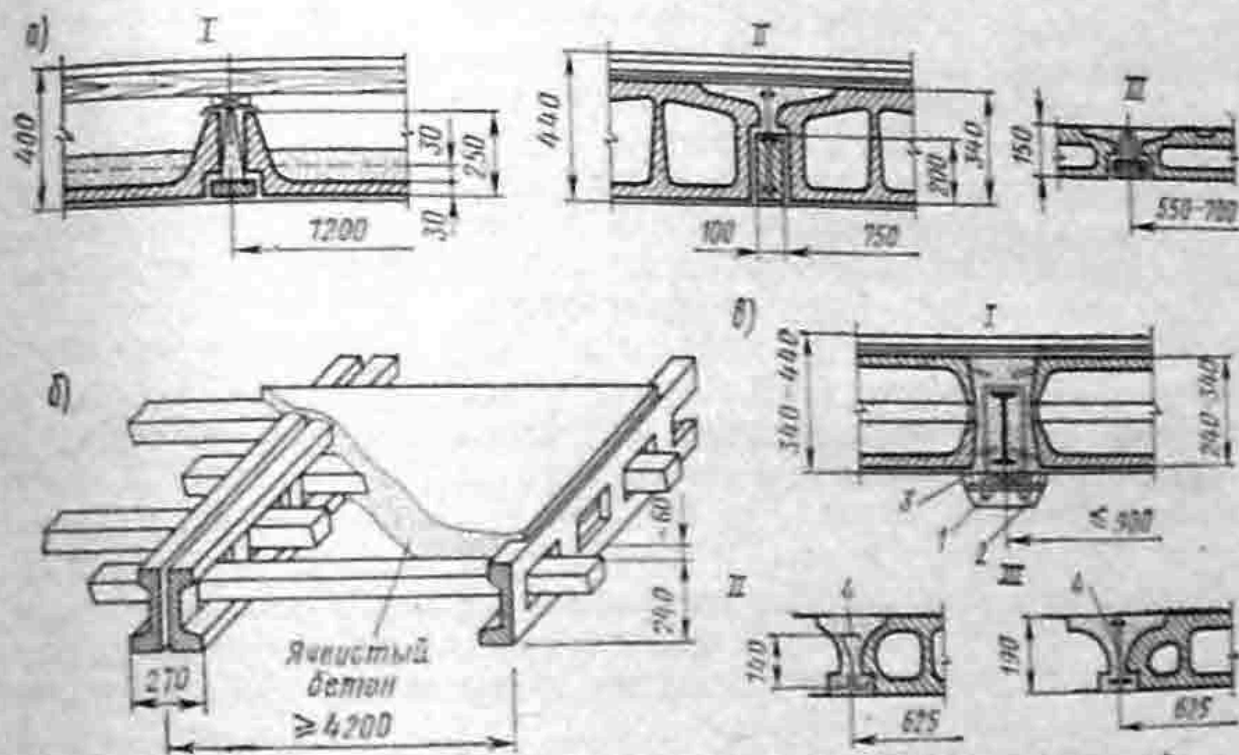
Сборно-монолитные перекрытия из малообъемных деталей:
